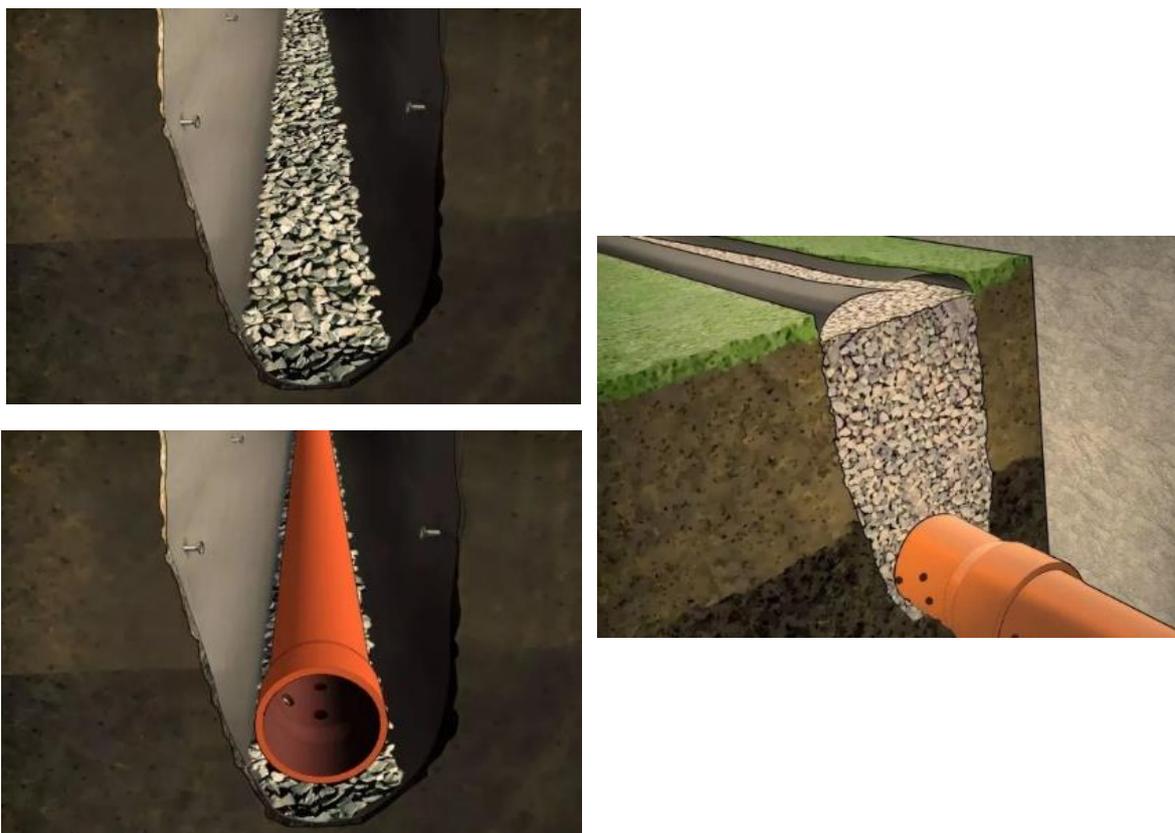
Etapas de Construcción del Drenaje Francés del proyecto
